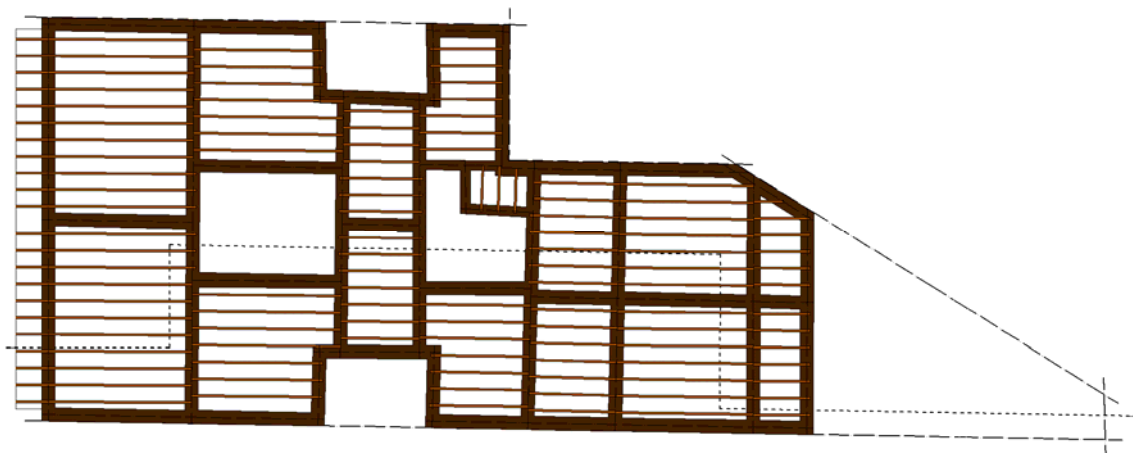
Forjado de planta 2ª. Fuente propia.
